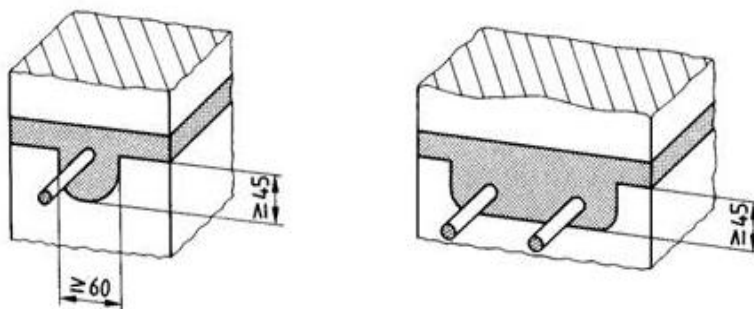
Horizontale Bewehrung in Formsteinen.
